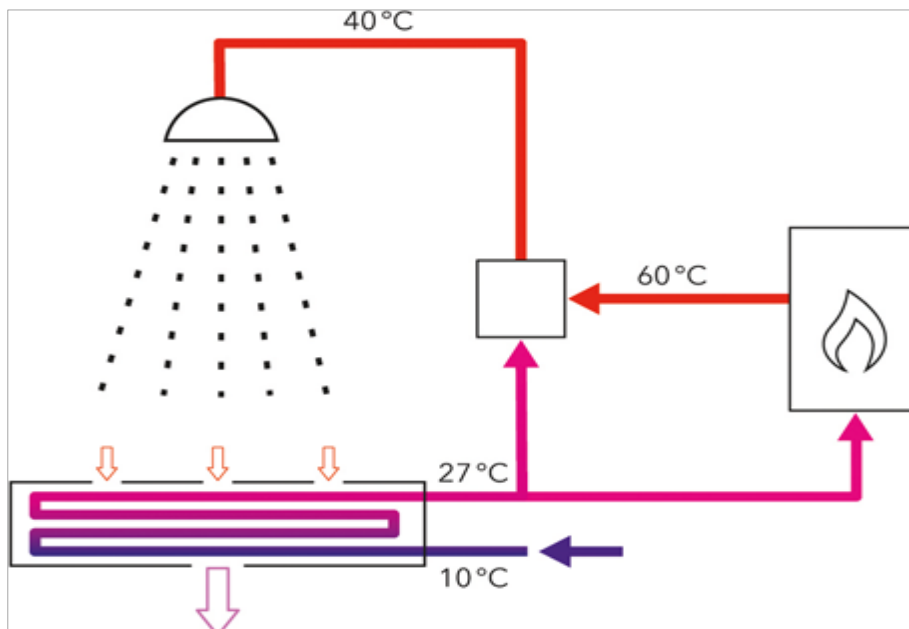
Installationsschema Duschwasser-Wärmerückgewinnung in Form einer Duschrinne.
